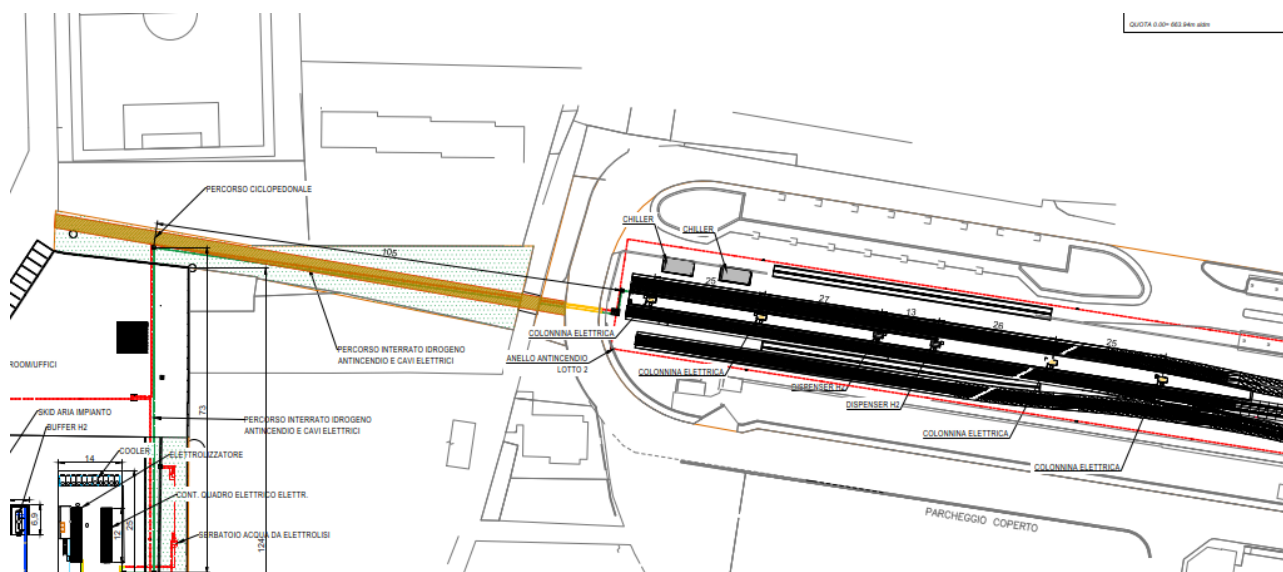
Particolare – Planimetria stato di progetto Lotto 2.
